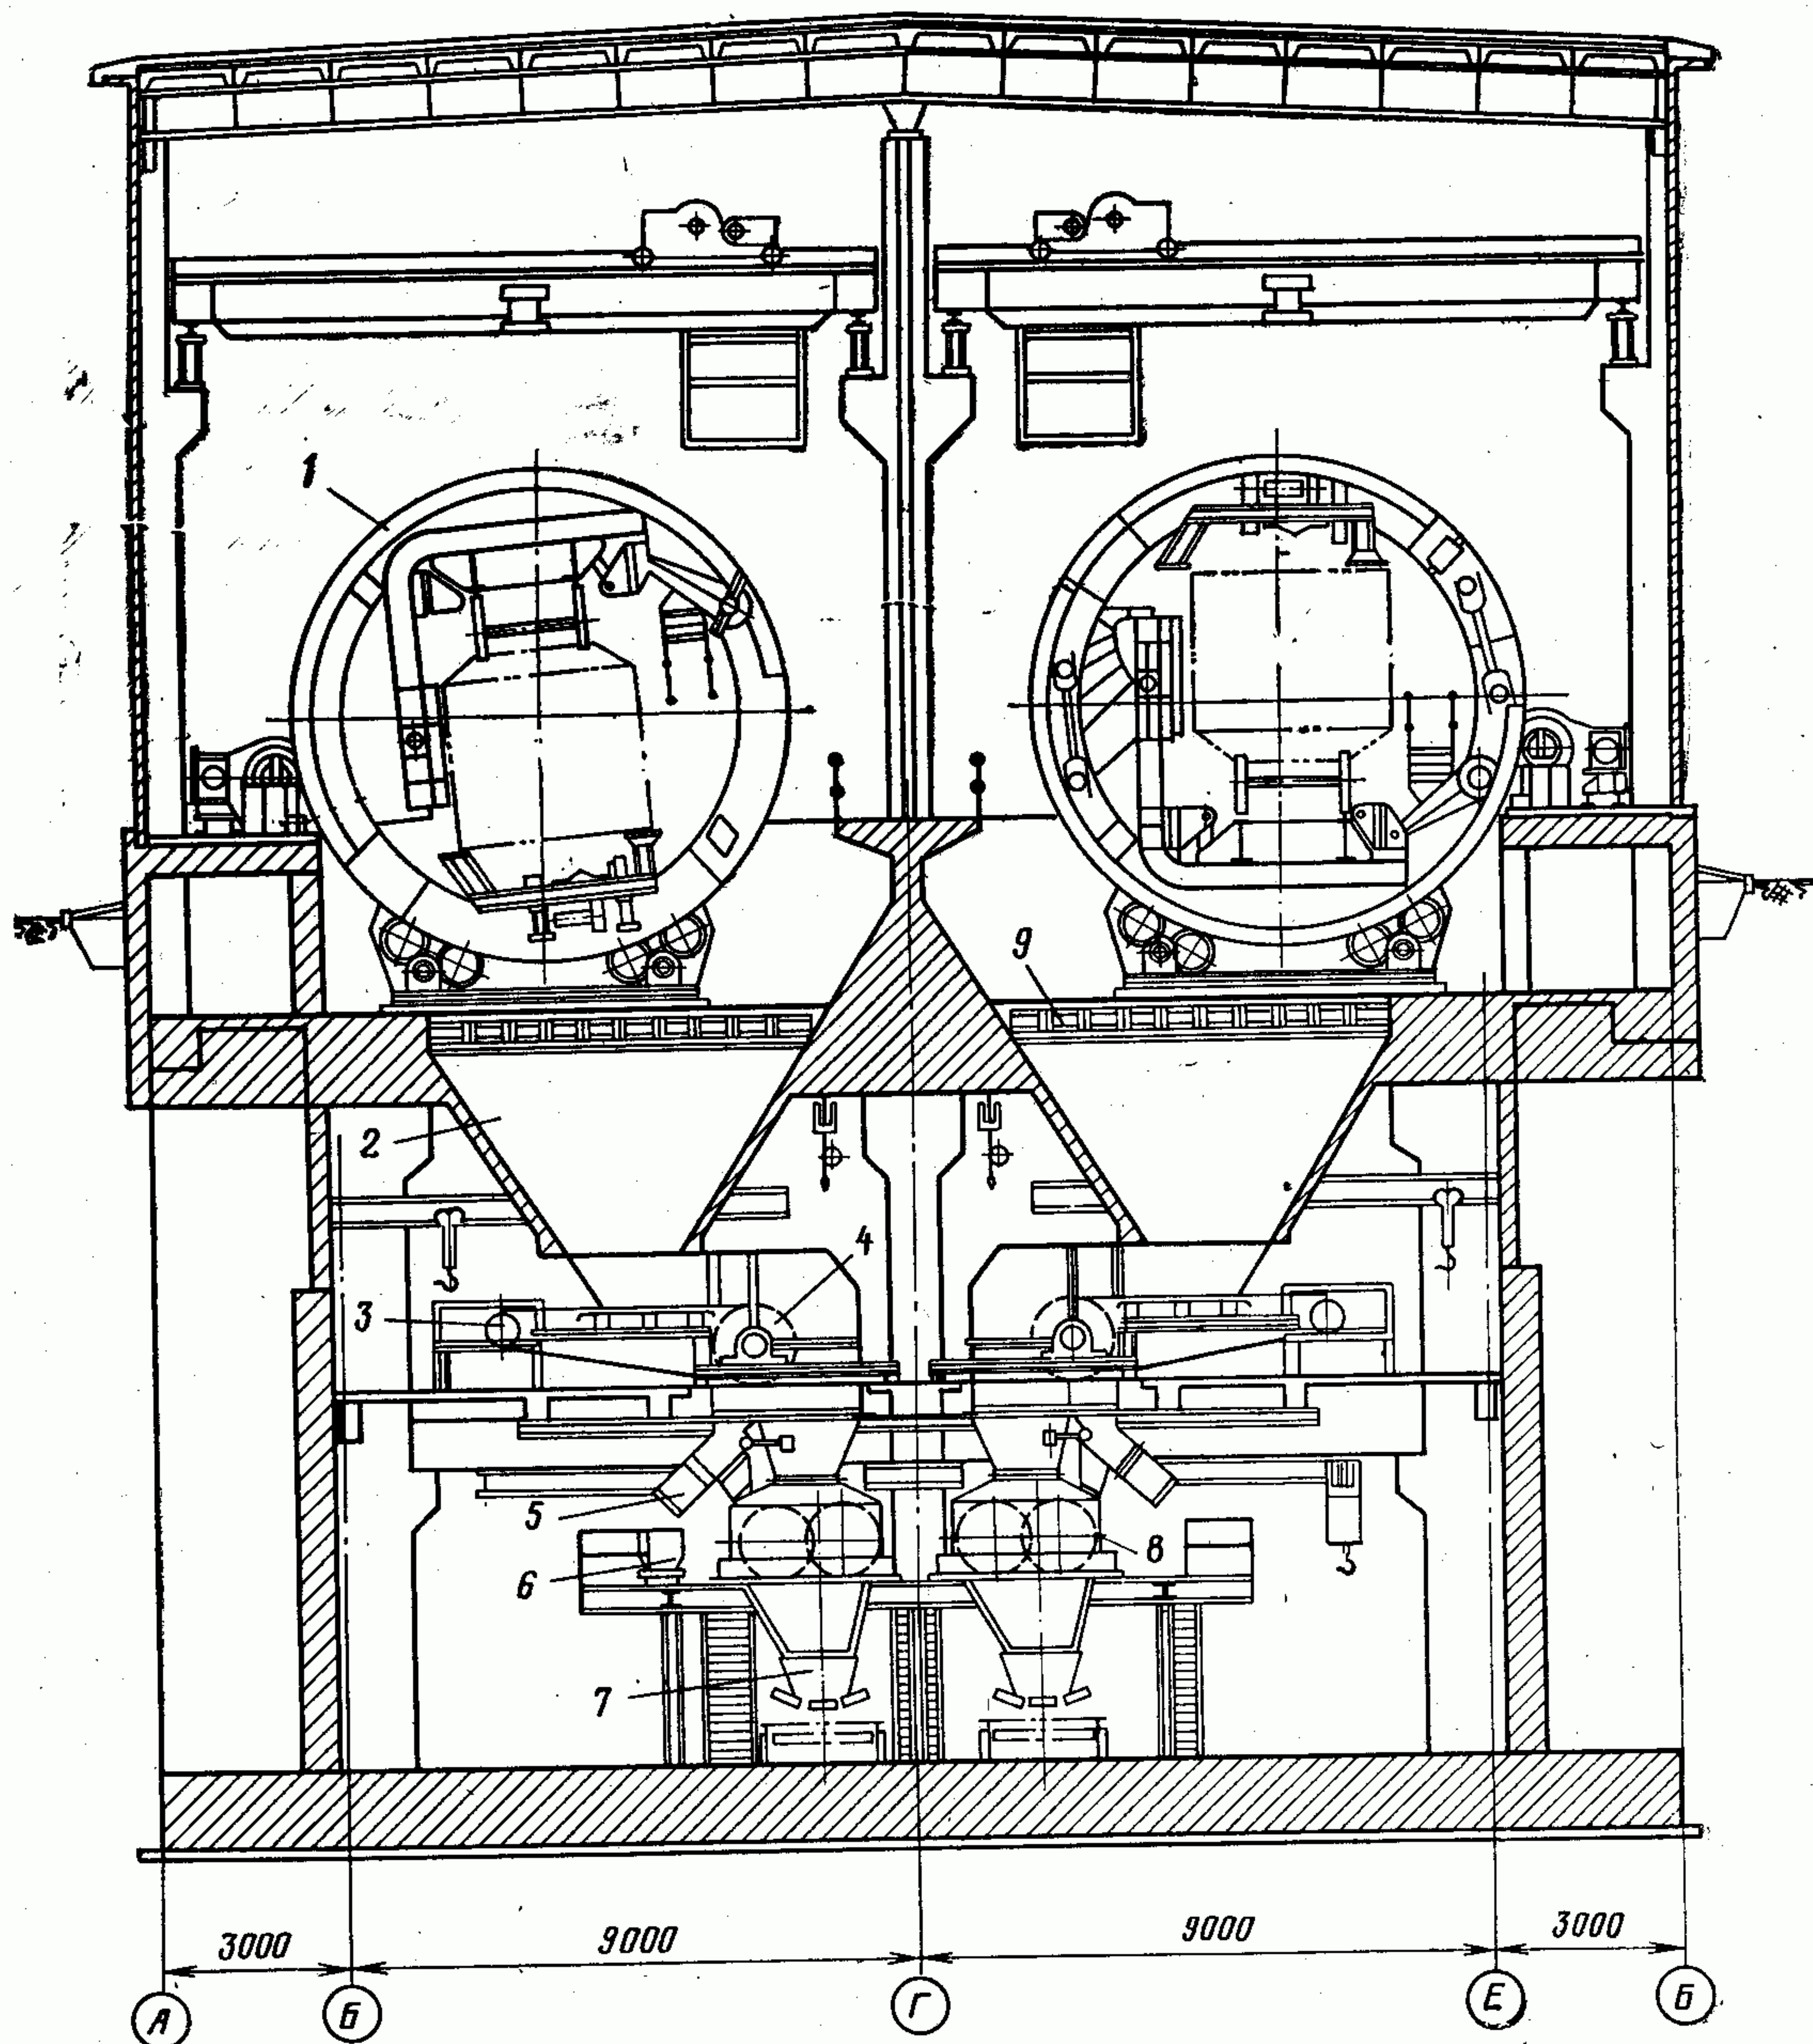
Разгрузочное устройство с двумя роторными вагоноопрокидывателями.
